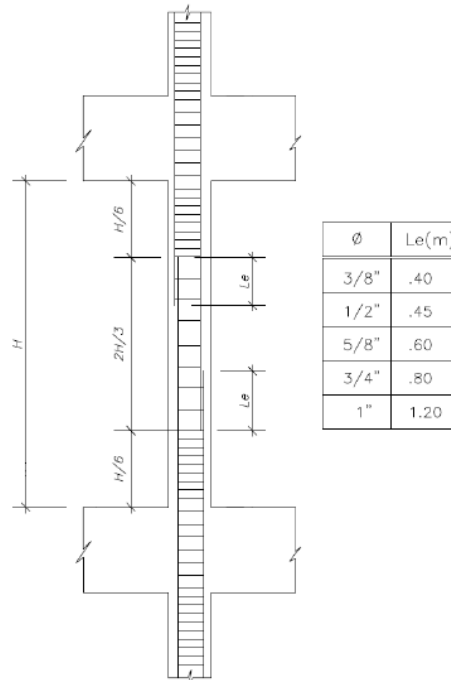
Empalmes traslapados para columnas (Norma E.060).
